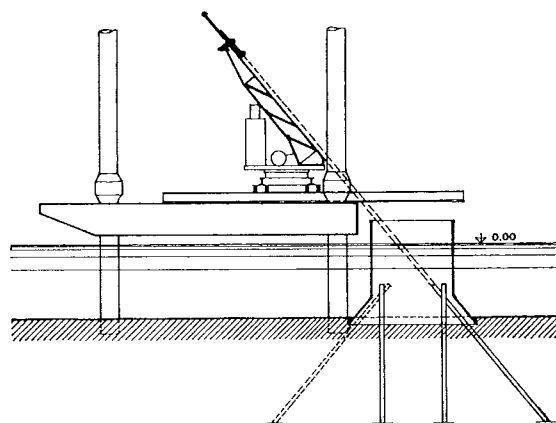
Infissioni pali prefabbricati con ausilio di piattaforma autosollevante.
